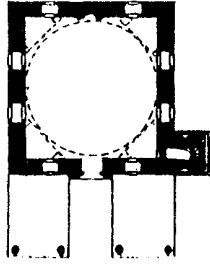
مسقط أفقى لمسجد قاسم
